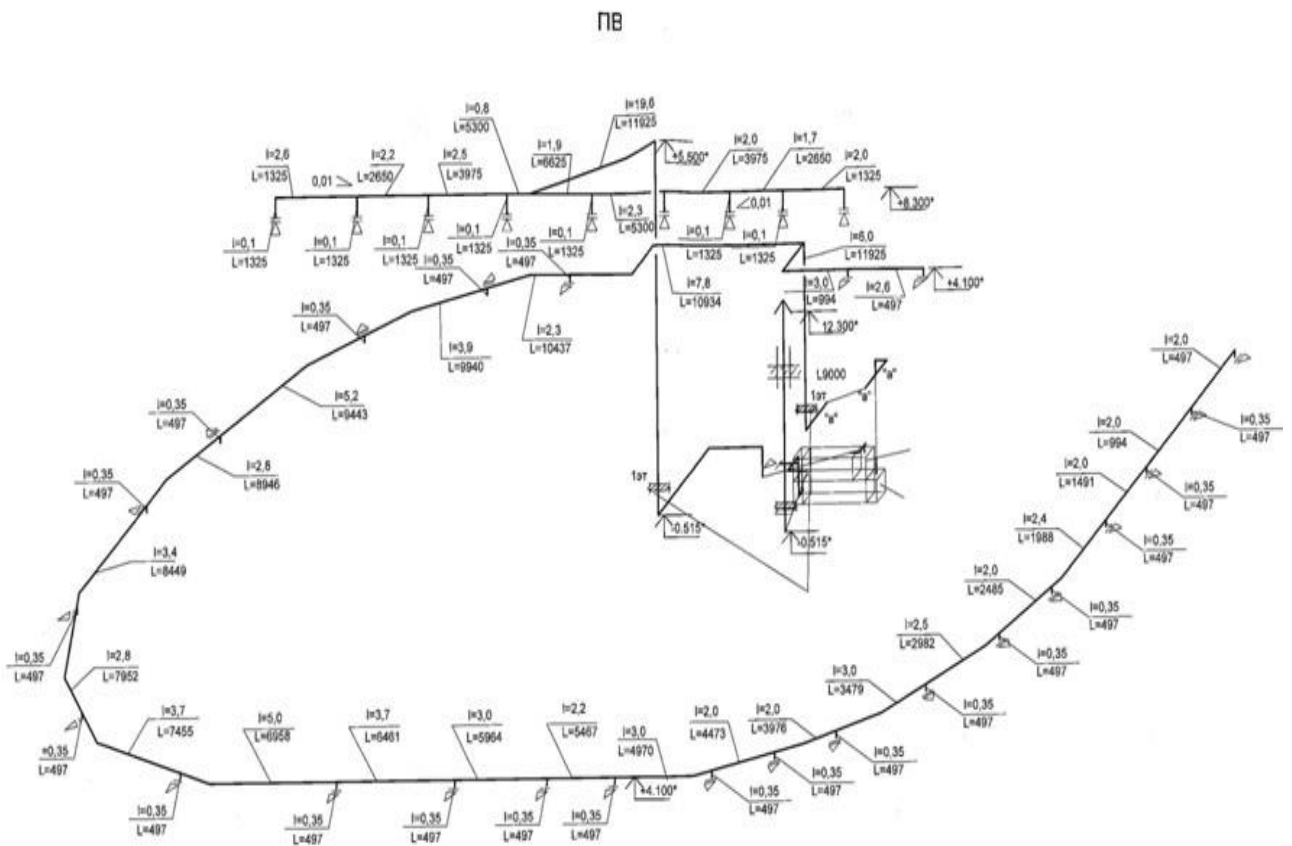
расчетная схема системы вентиляции в помещении бассейна
